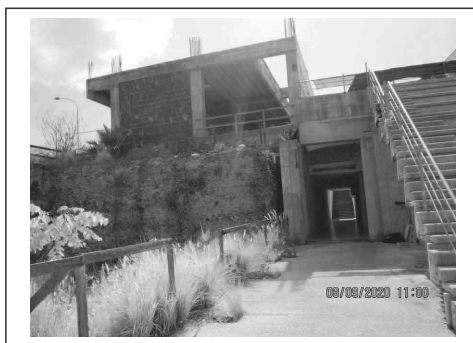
Ingresso ai corridoi coperti che conducono all'auditorium dalla zona antistante la gradonata esterna
